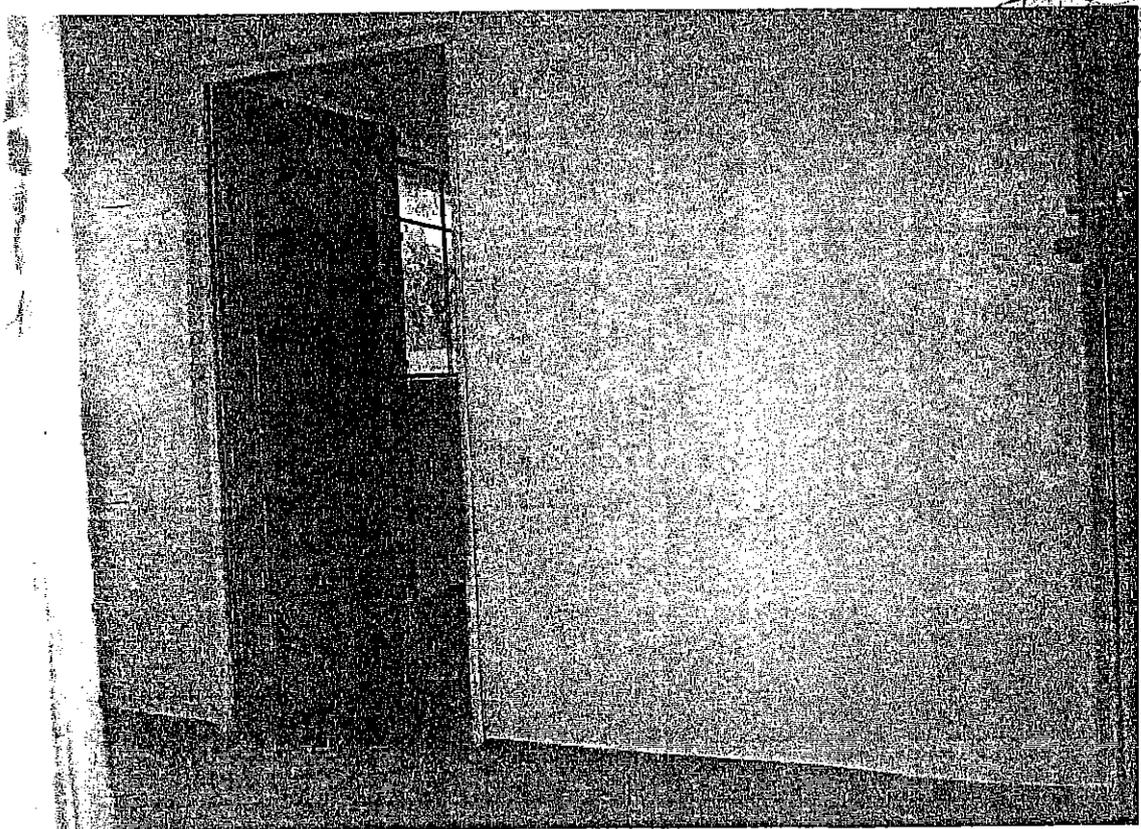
Fotografía de semi-conjunto, en la que se aprecia el interior de la segunda planta de la edificación.
